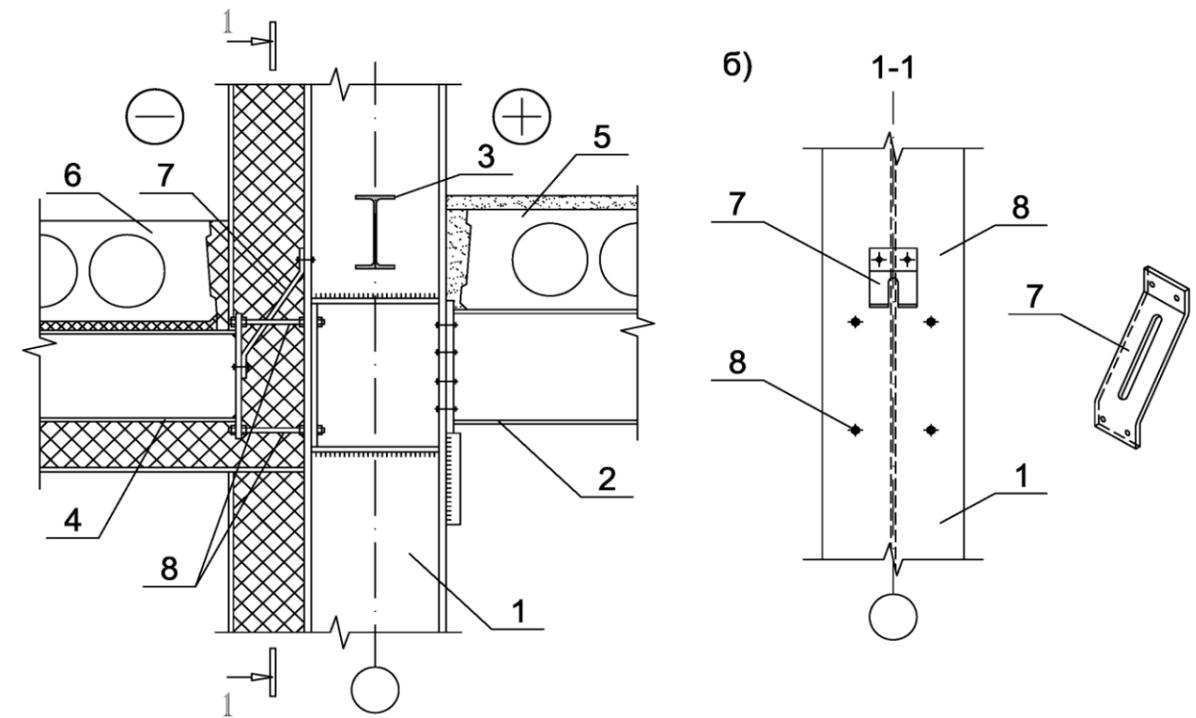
Схема устройства стальной консоли балкона со стороны связевой балки. 1 – колонна; 2 – главная балка; 3 – связевая балка; 4 – консоль балкона; 5 – плита перекрытия; 6 – плита перекрытия балкона; 7 – подвеска; 8 – связевые болты.
